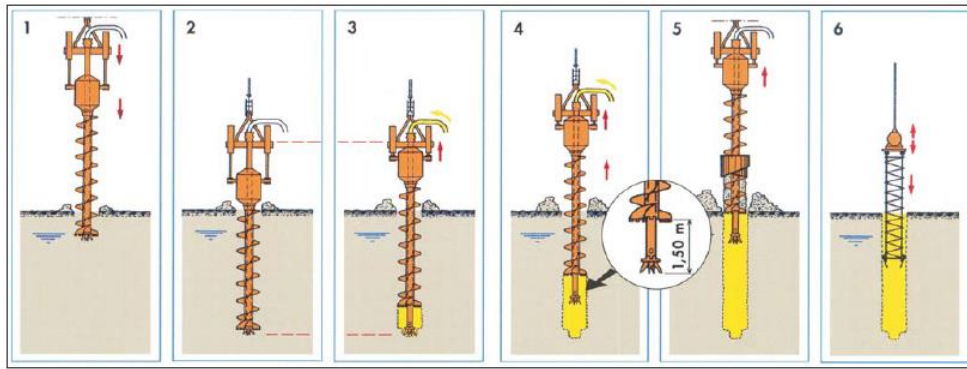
Construcción de pilas con barrena CFA.¹⁵
